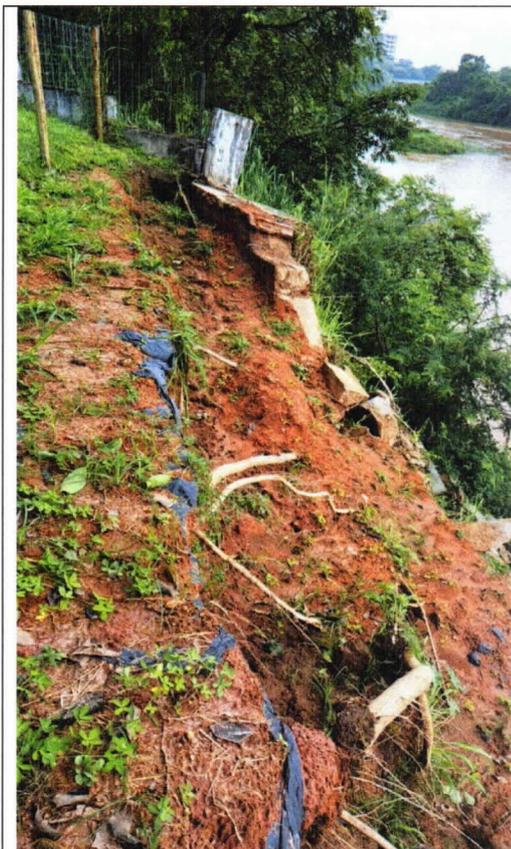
Vista geral do muro colapsado as margens do Rio Paraíba do Sul;
